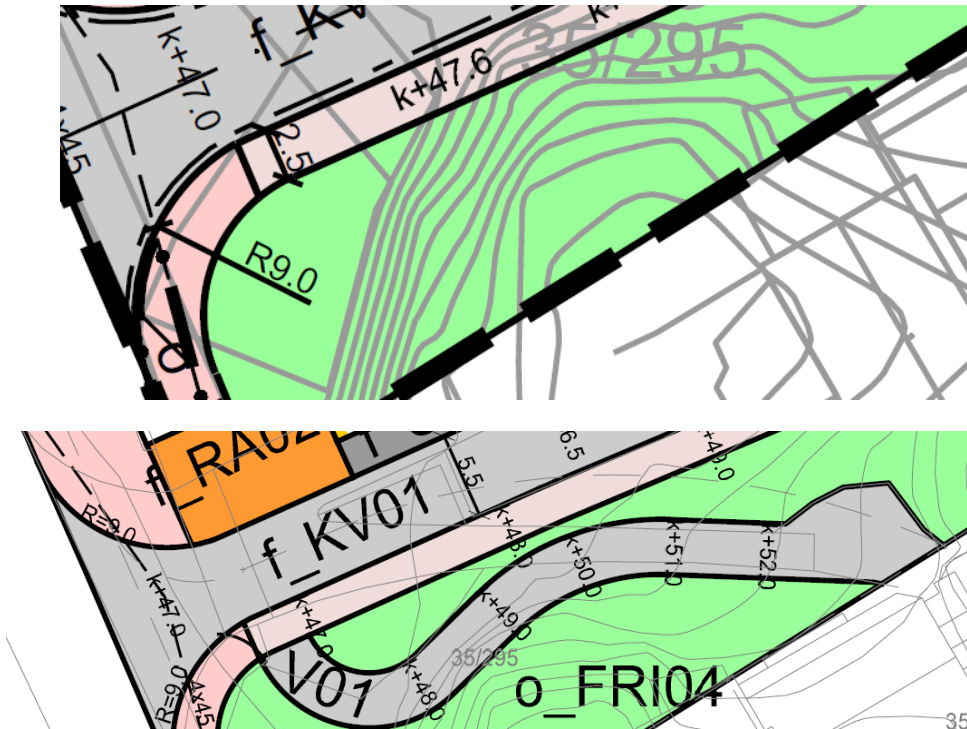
viser renovasjonsareal f_RA02 i gjeldande plan til venstre, og endra situasjon med større renovasjonsareal til høgre.
